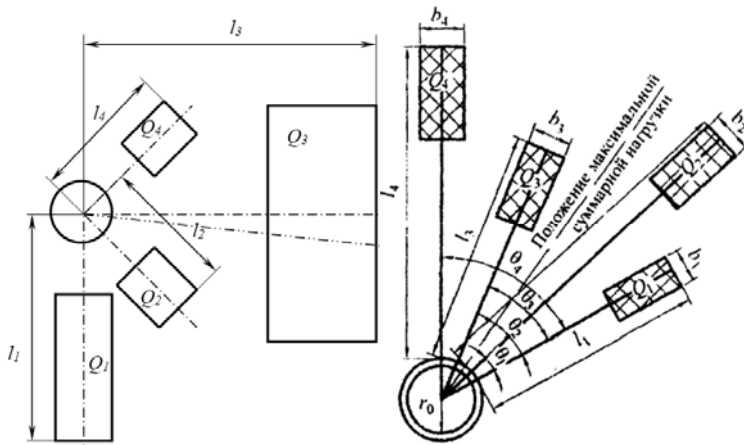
Расчетная схема для определения дополнительного давления, создаваемого оборудованием, зданиями и сооружениями, расположенными на строительной площадке вертикального ствола
